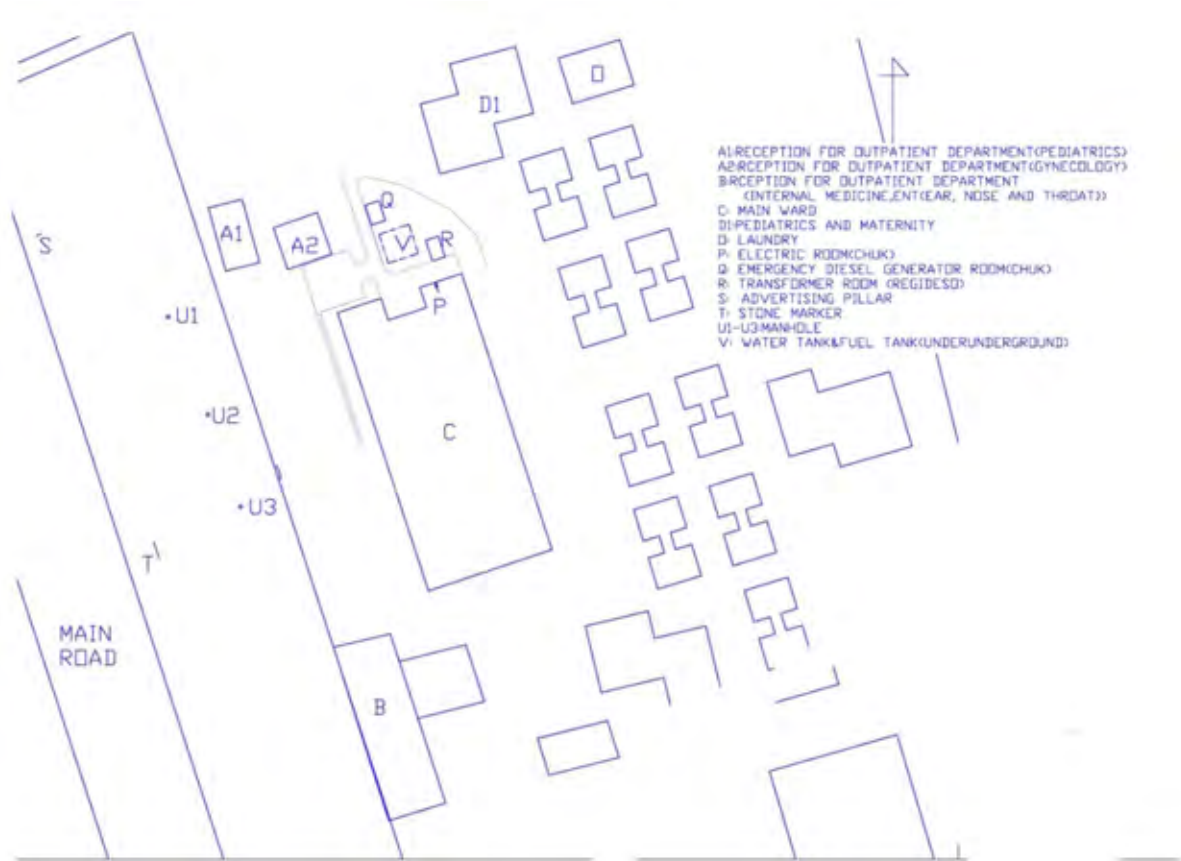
Plan de disposition des installations à l'intérieur du CHUK
